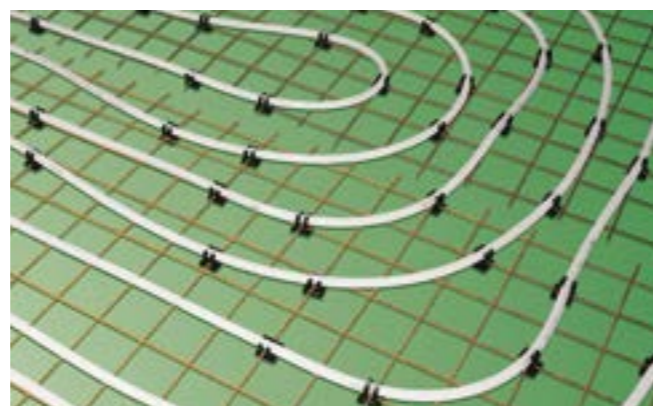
Isolamento termico con riscaldamento a pavimento.
